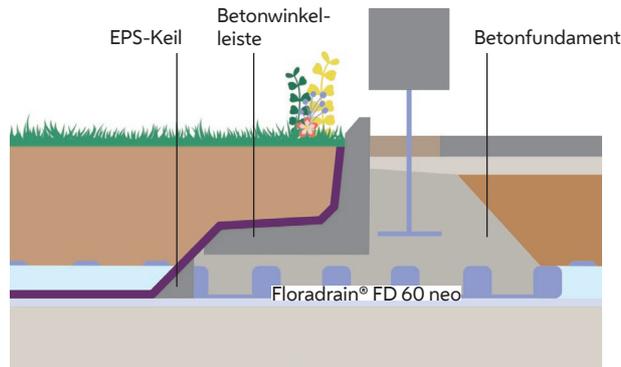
Auflastverankerung mit einem Betonfundament aus Ort- und Fertigbeton (GREEN4CITIES nach ZINCO, 2024)
